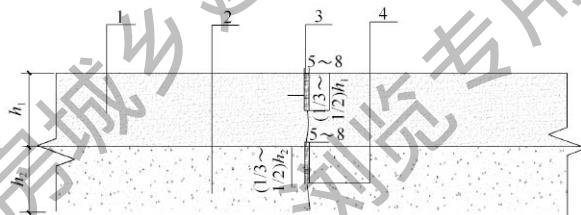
半透水水泥混凝土路面缩缝构造（单位：mm）
